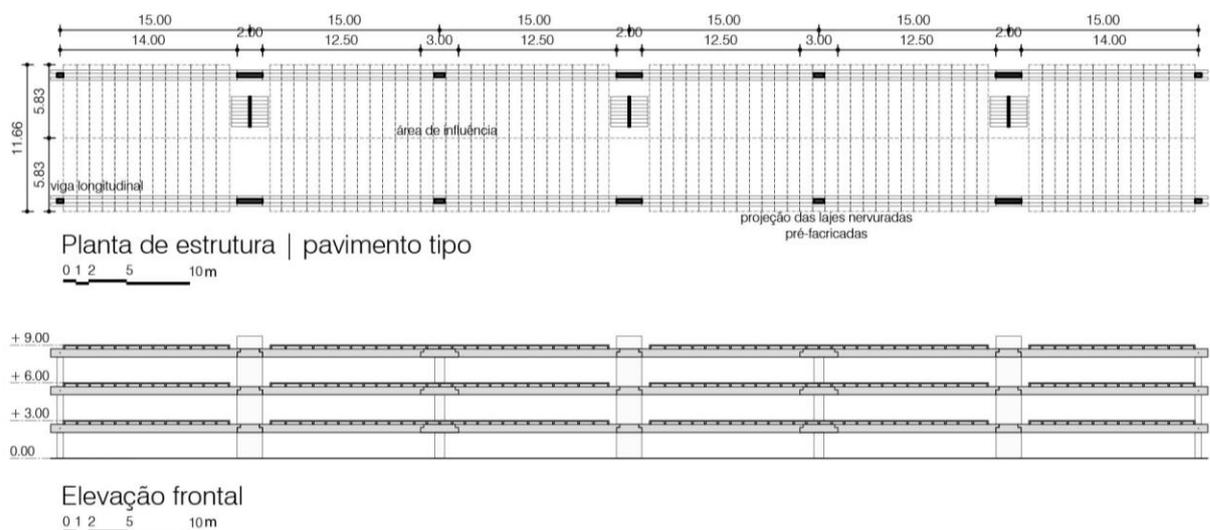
Planta estrutural e elevação frontal da simulação 1: Elaborado pelo autor
